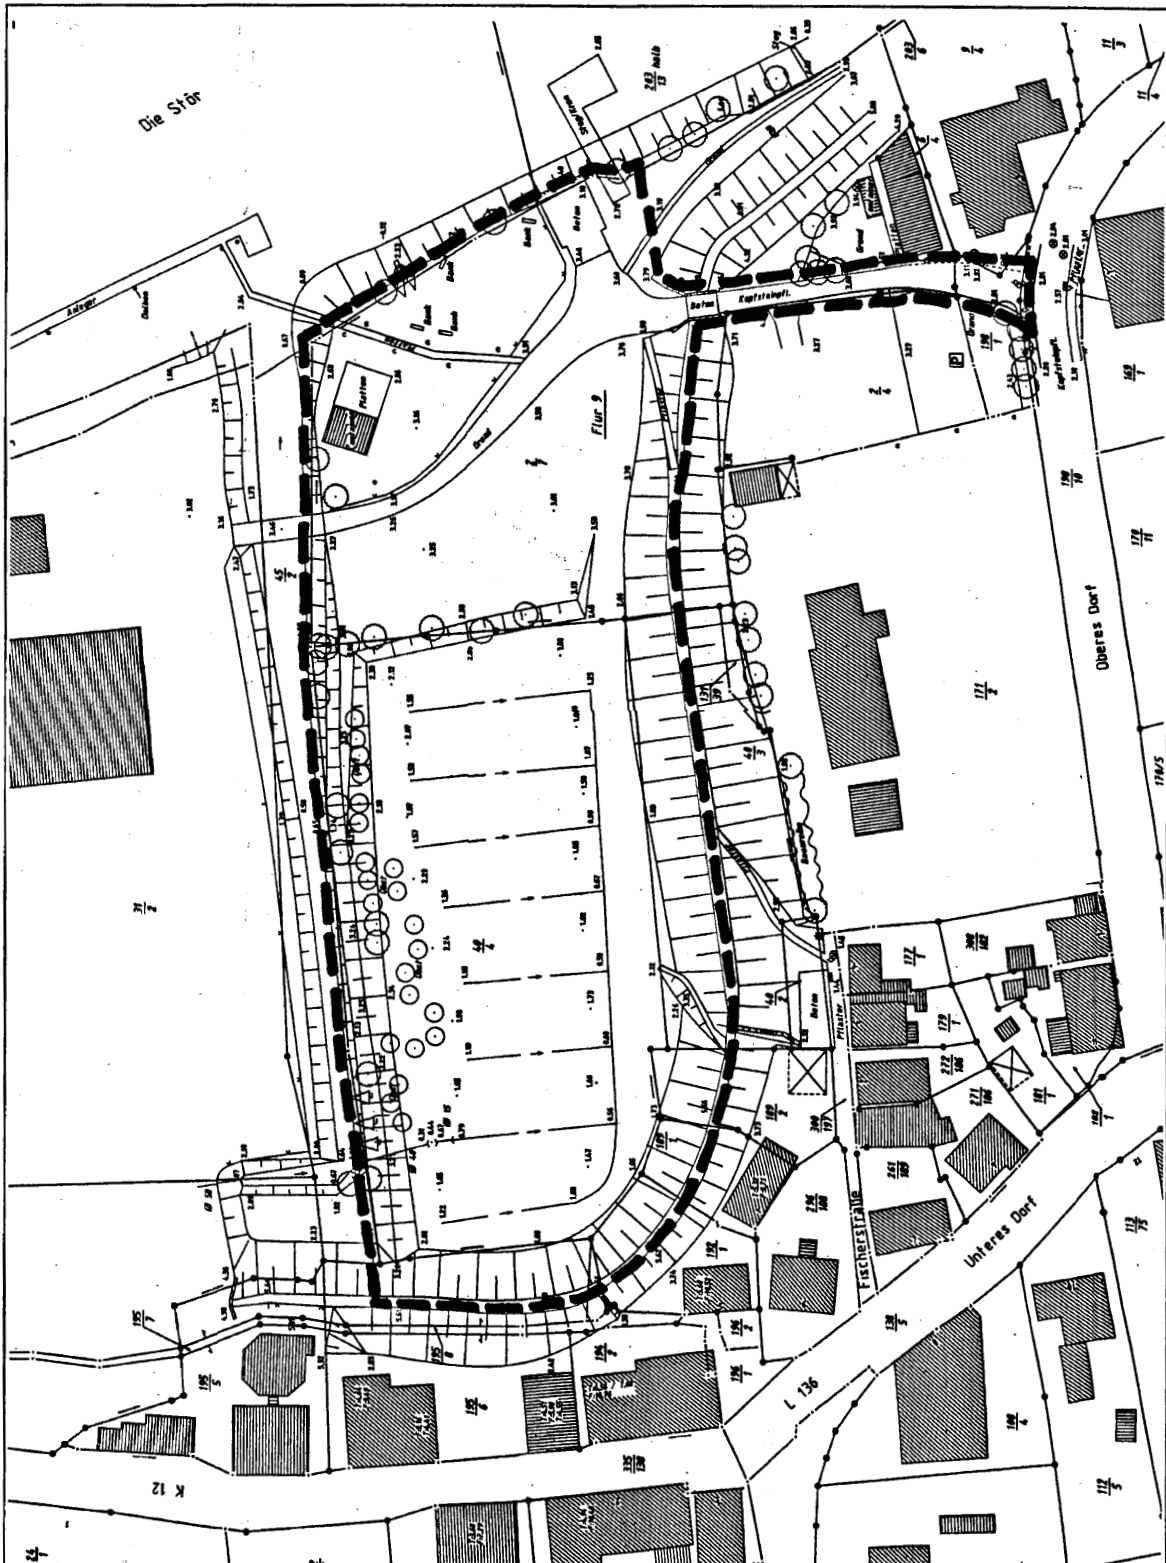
Abgrenzung und Lage des Plangebiets zur vorhandenen Siedlungsstruktur auf Grundlage des Lage- und Höhenplanes vom 24.06.2001 als amtliche Planunterlage, unmaßstäblich
